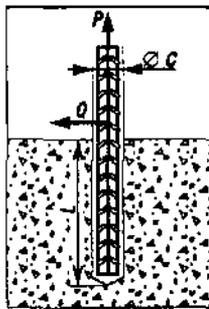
Dimensions standard des boîtes d'attentes STABOX.
